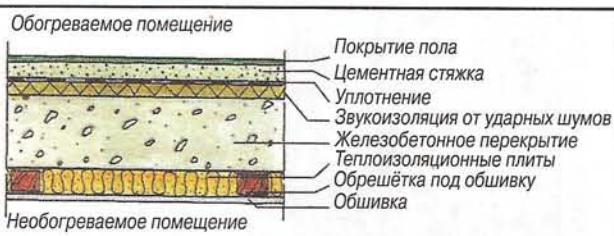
Подвальное перекрытие с теплоизоляцией снизу.
